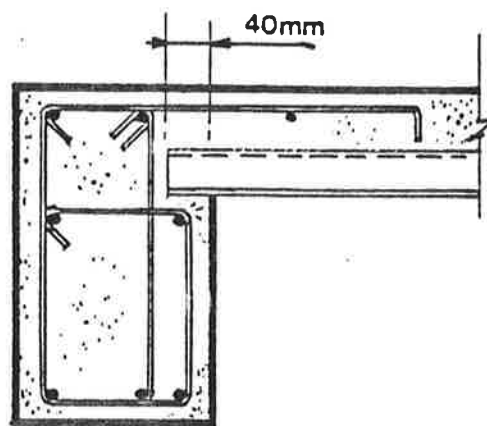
Concretagem simultânea laje composta-viga de concreto armado. (28)
